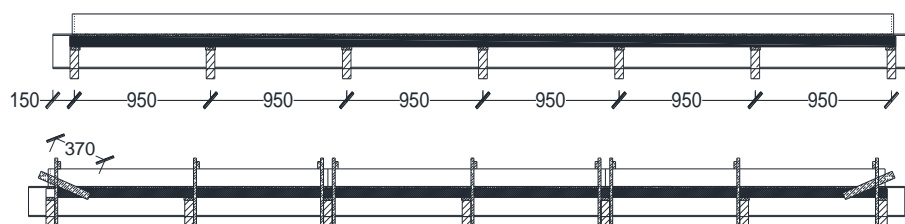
Solda de aplicação do CT e enrijecedor no perfil de aço.
